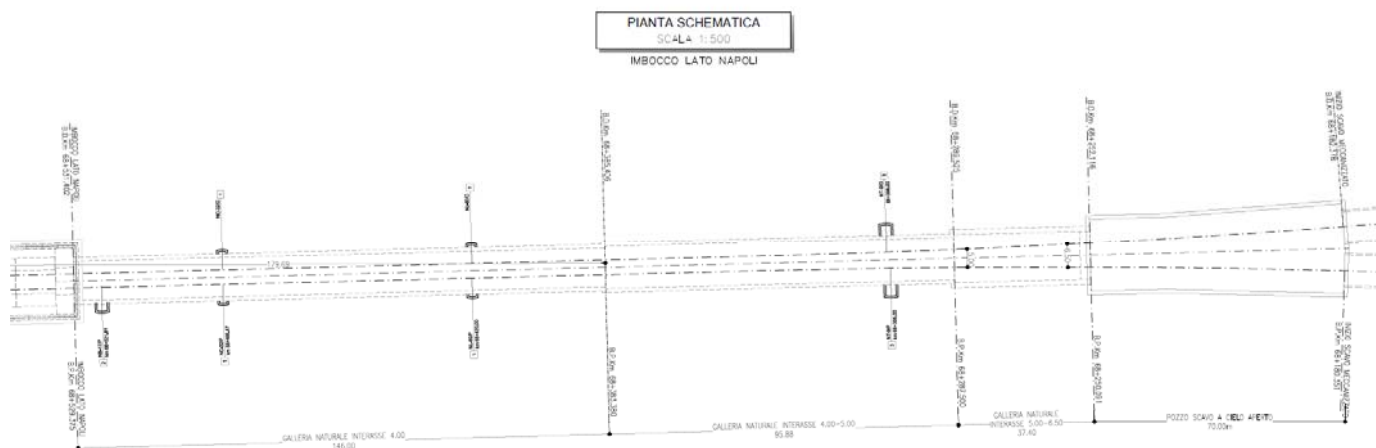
planimetria generale tratta in tradizionale lato Napoli
